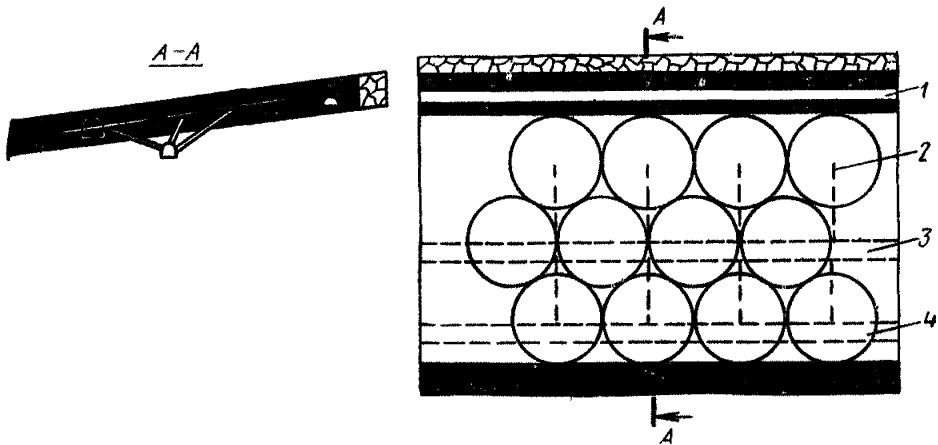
Трехрядное расположение скважин для гидроразрыва пласта:
